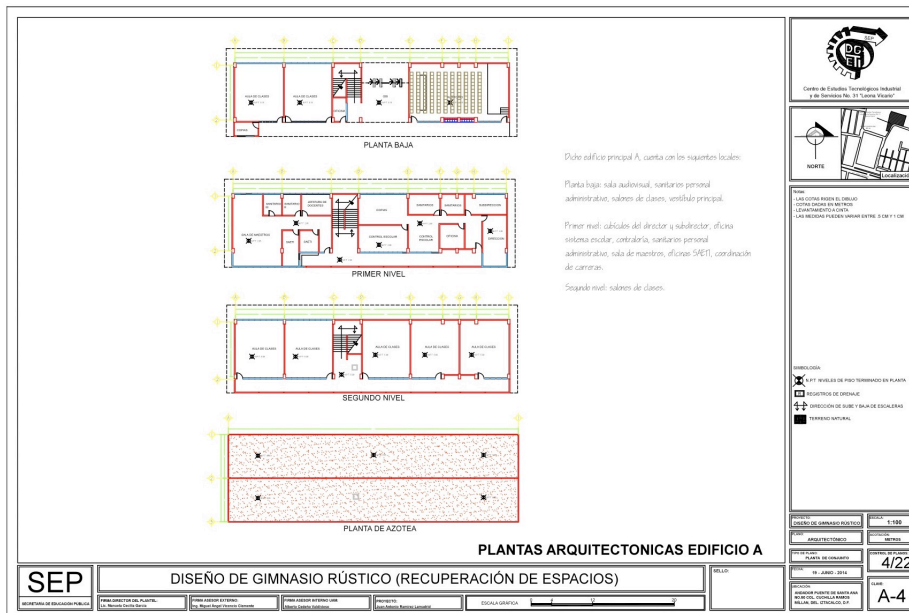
Plantas arquitectónicas edificio A, levantamiento por Juan Ramírez
